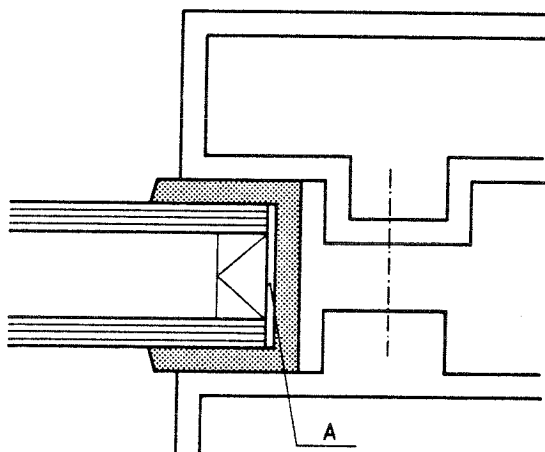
Beispiel einer Profilverglasung mit U-Profil und Spannelement
